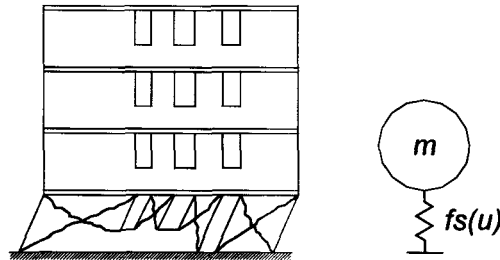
Modelo de un edificio con daño solo en la planta baja [2]
